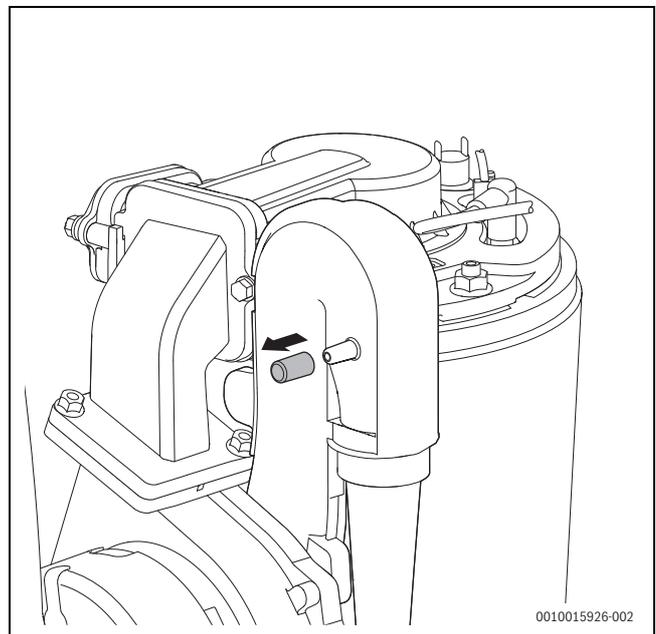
Tubulure de mesure sur le dispositif de mélange
